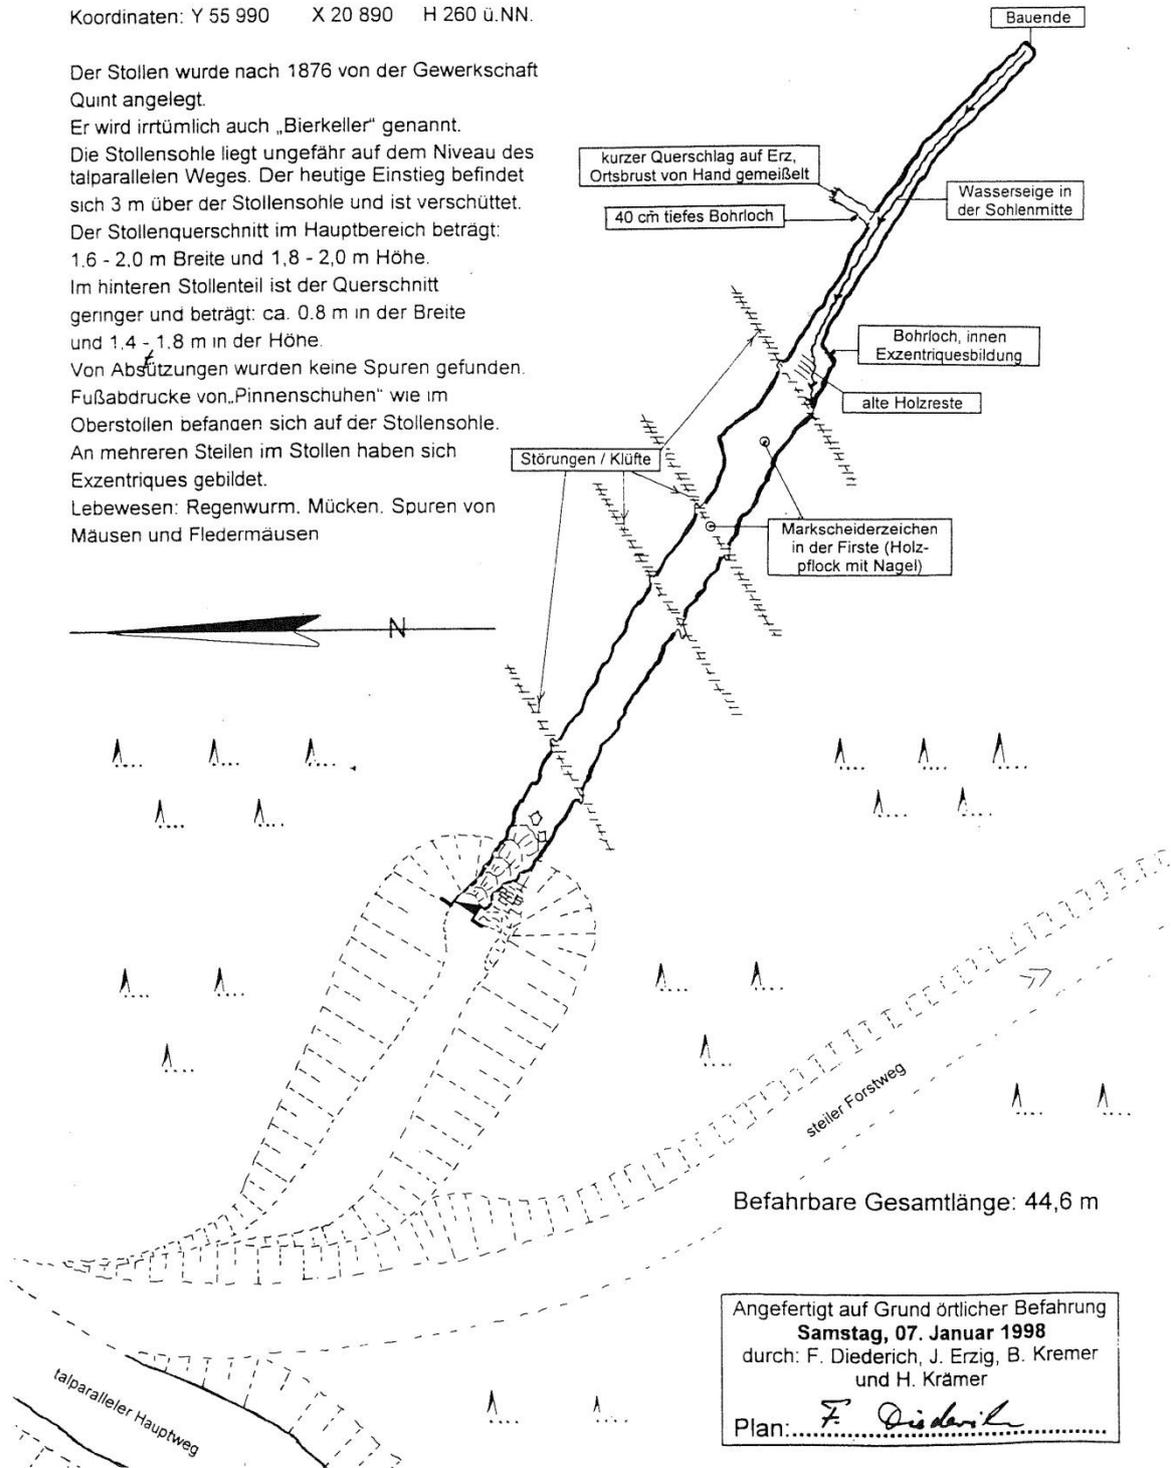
Grundriss Mutung „Bierkeller“
